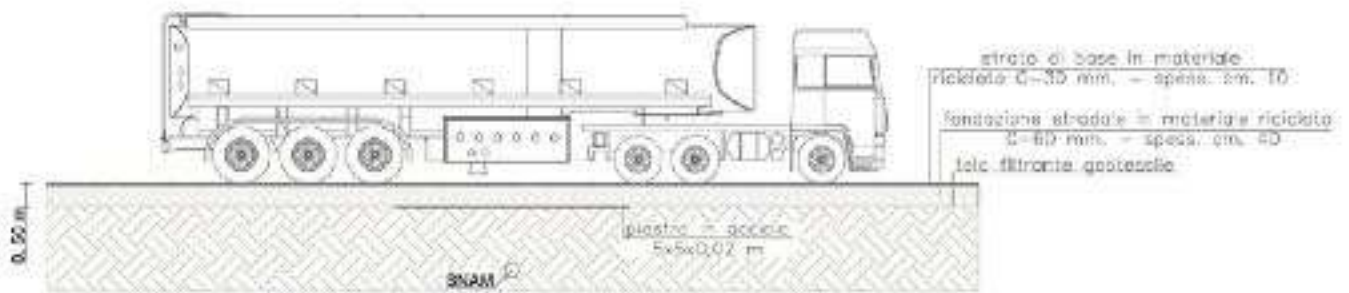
Schema risoluzione dell'interferenza stradale con posizionamento della piastra in acciaio.
